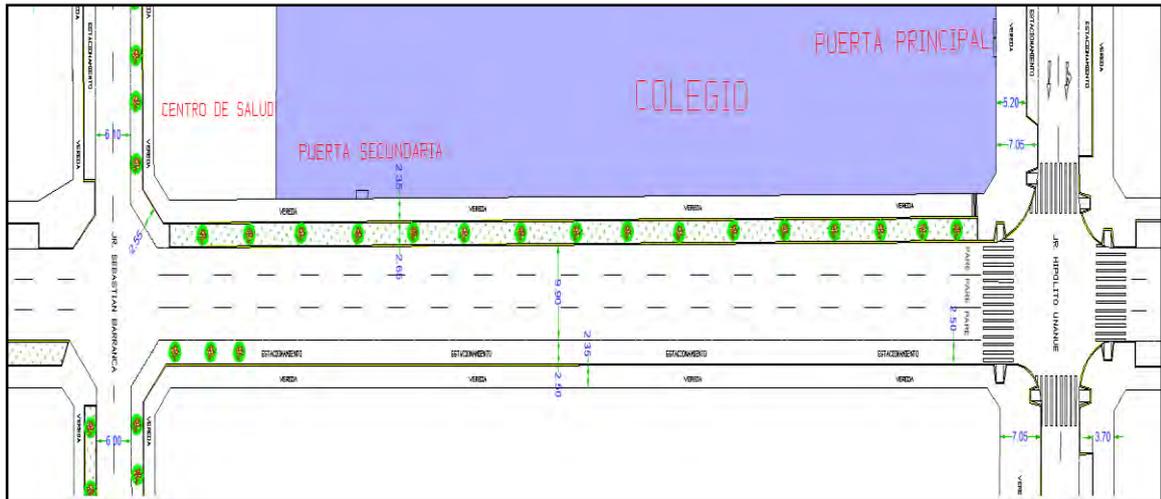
Vista en planta de situación actual en la Av. Cangallo frente al colegio.
